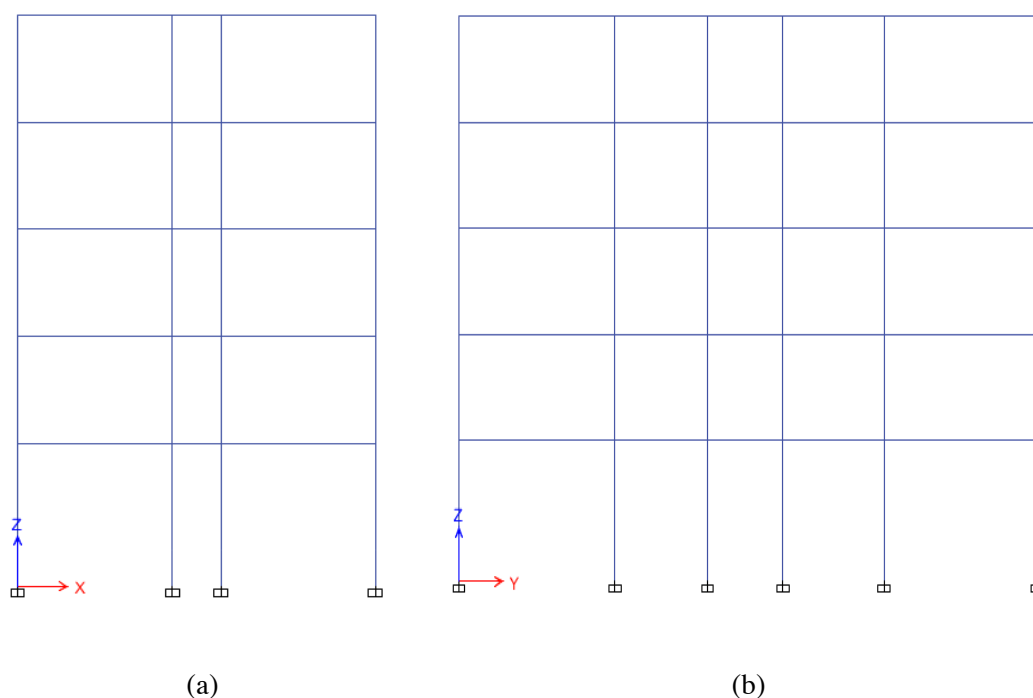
Edificio tipo 5B-S y 5B-C. (a) Alzado. (b) Perfil
